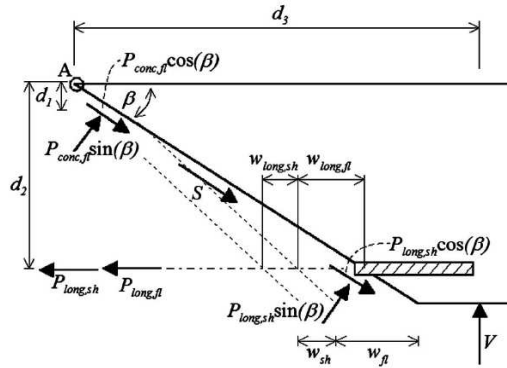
a. Fuerzas movilizadas en una sección fisurada sin armadura transversal (Lucas y Oehlers)
